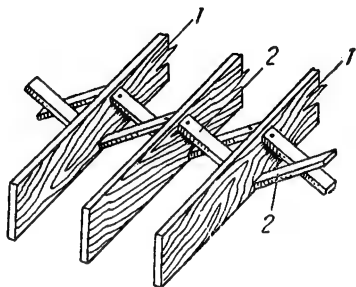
Contravîntuirea transversală a planșeelor din dulapi de lemn :
